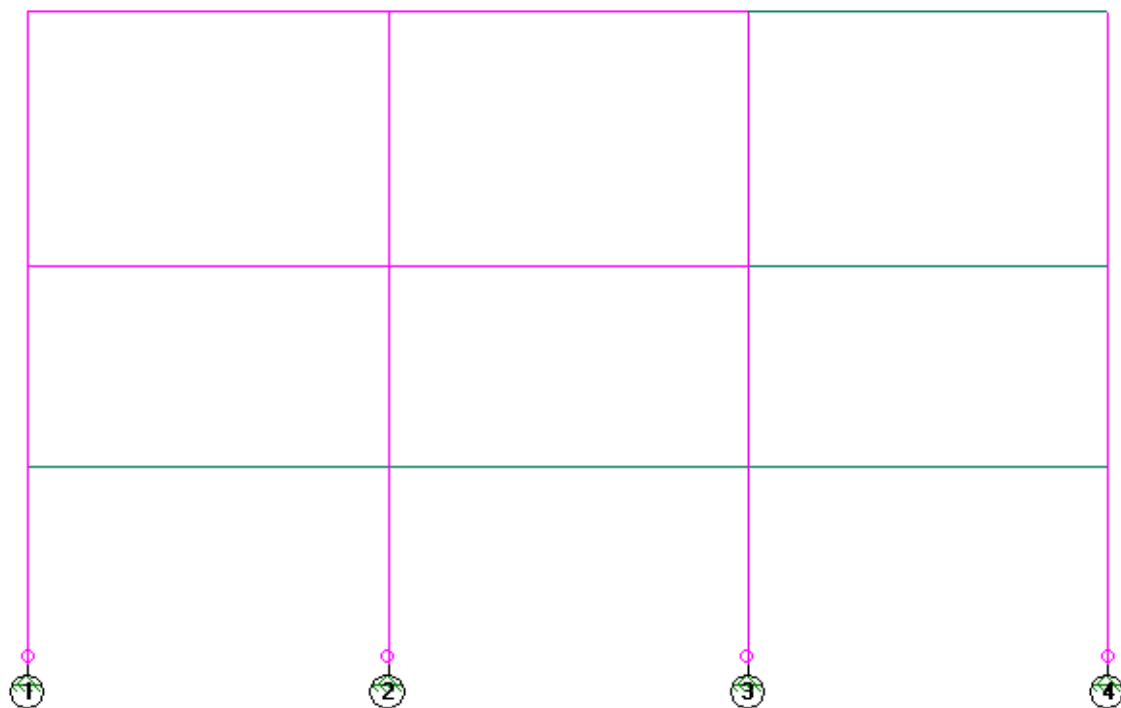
Modelo Estrutural – Elevação do Eixo A
